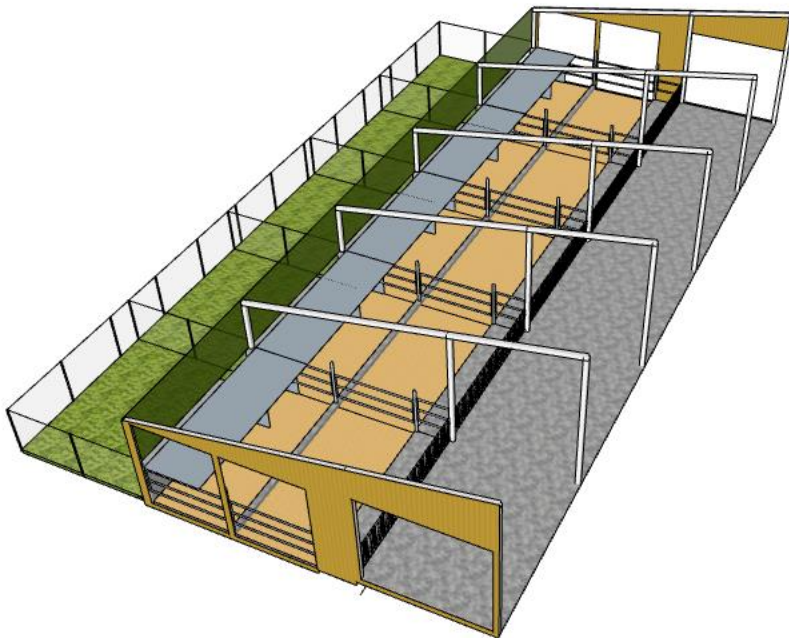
Kälberstall nach dem Holsteiner System mit Mikroklimadeckeln und Ausläufen
